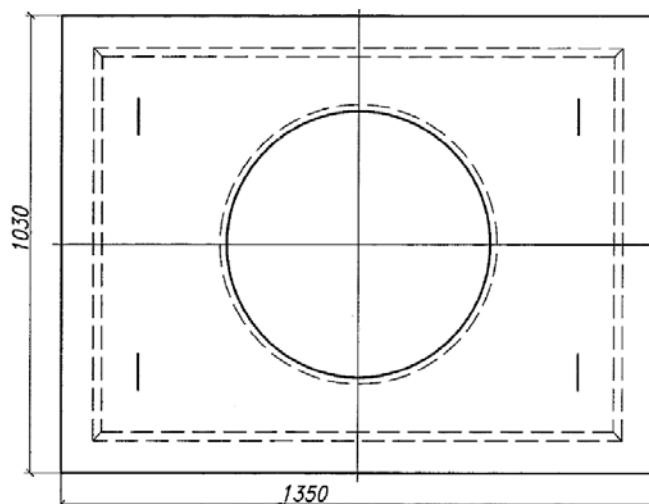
Размеры плиты перекрытия (вид сверху).
